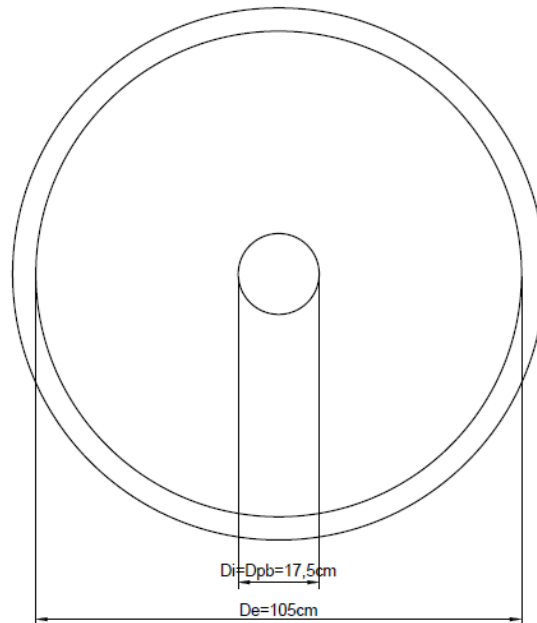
Esquema de configuración del Aislador LRB - Planta
